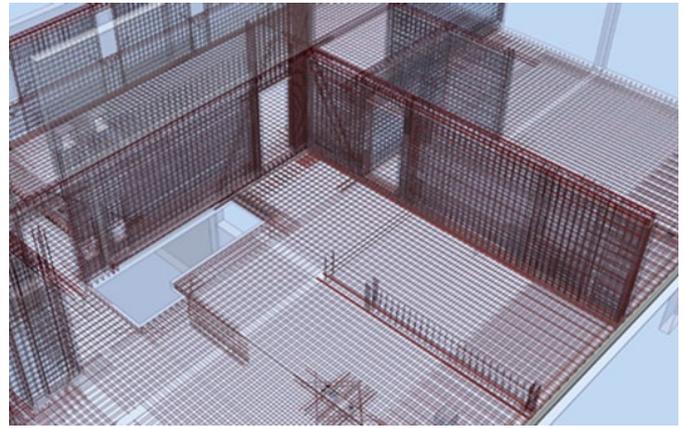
Isometrie Bewehrungsführung Abfangkonstruktion Wohnhaus 1 über der Fahrgasse zur Tiefgarage
